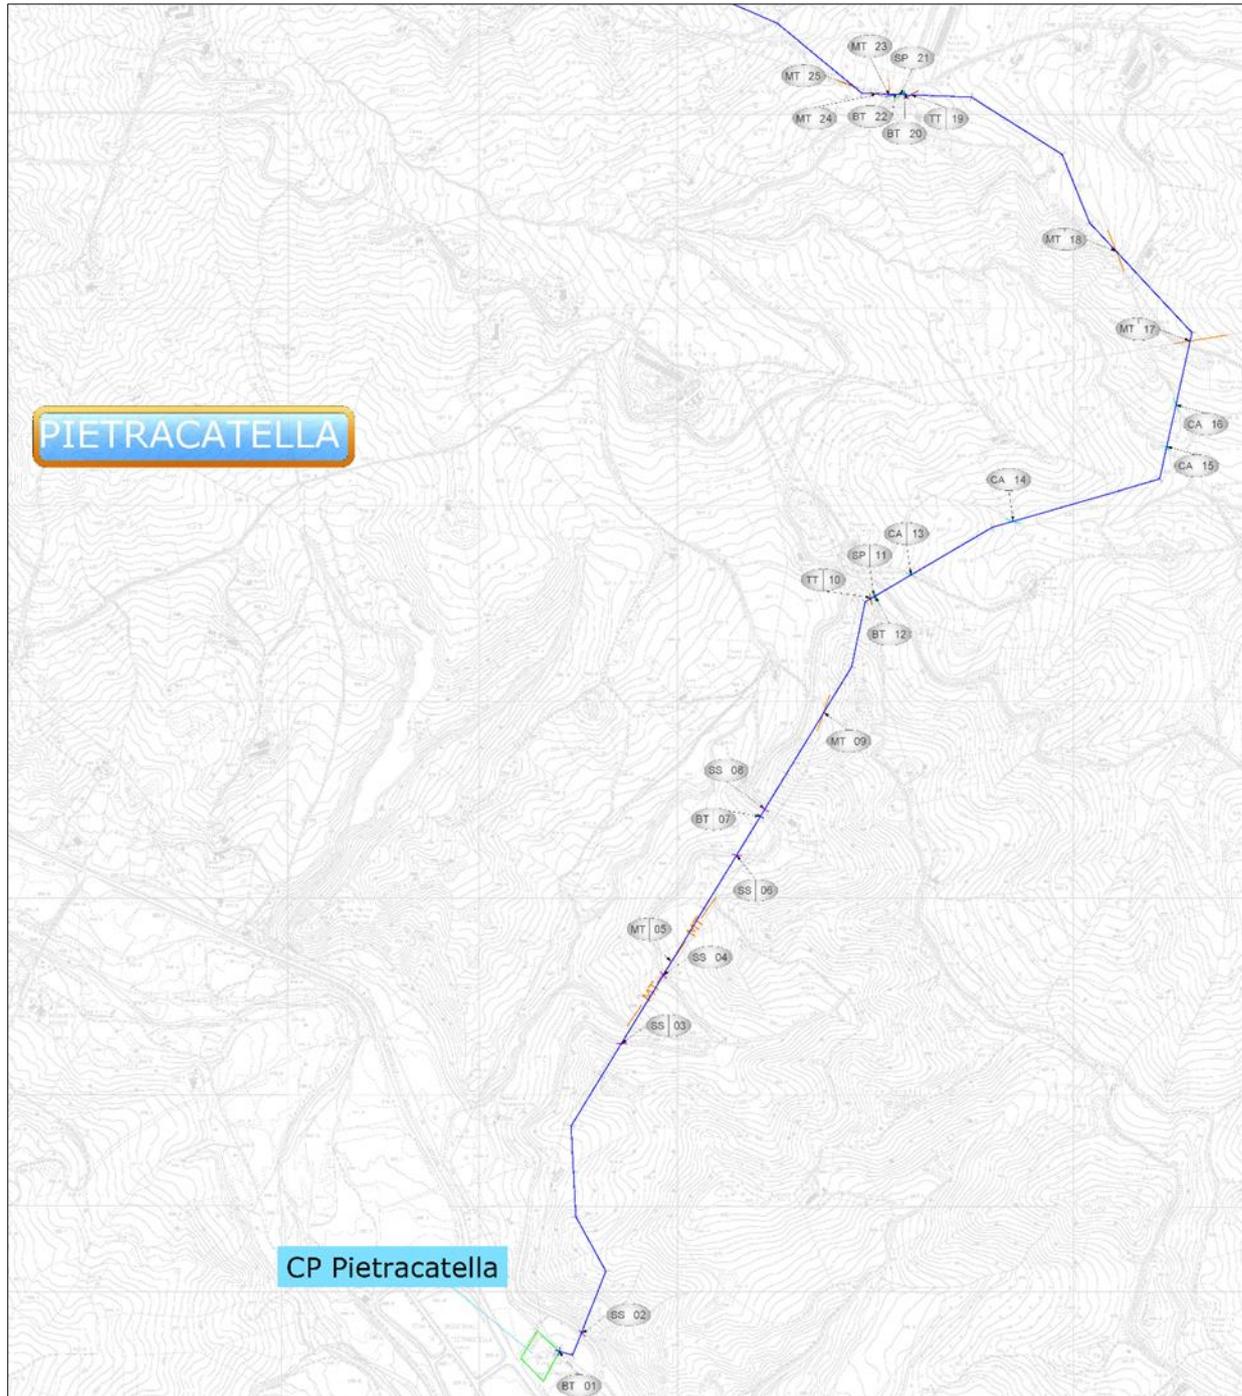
Stralcio planimetria tracciato elettrodoto su CTR (1/5)
